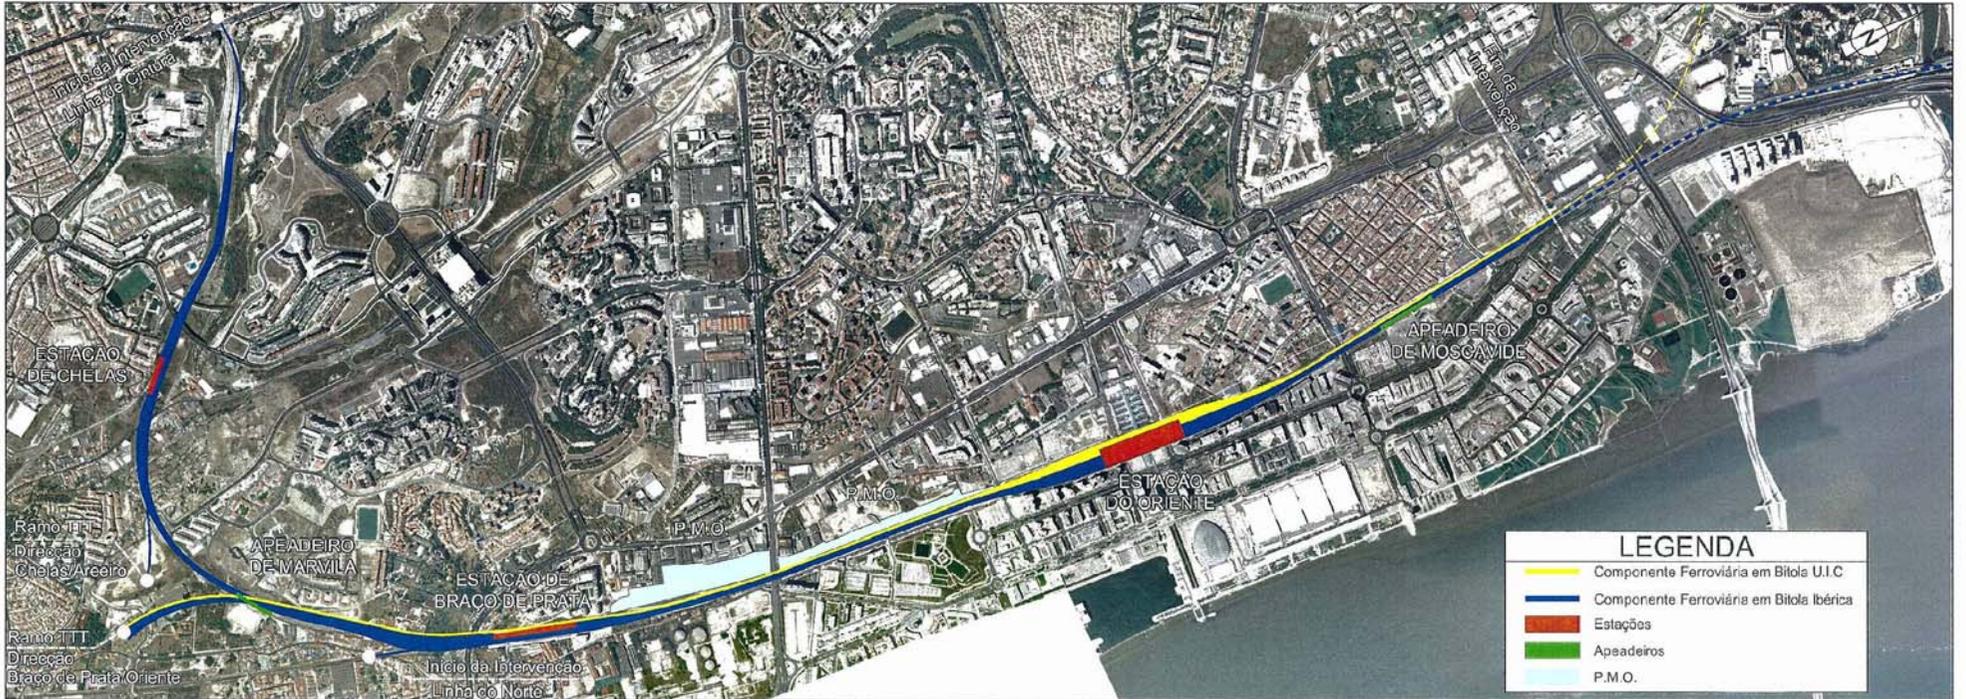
Planta de localização das intervenções a realizar no troço Areeiro - Sacavém
